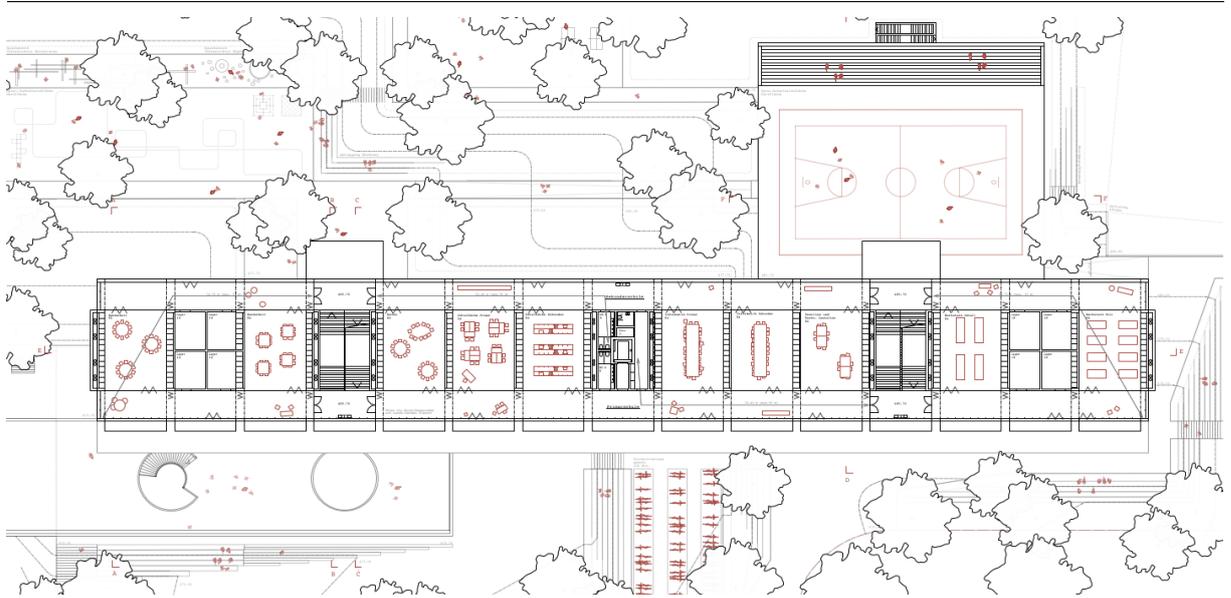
Grundriss 3. Obergeschoss
